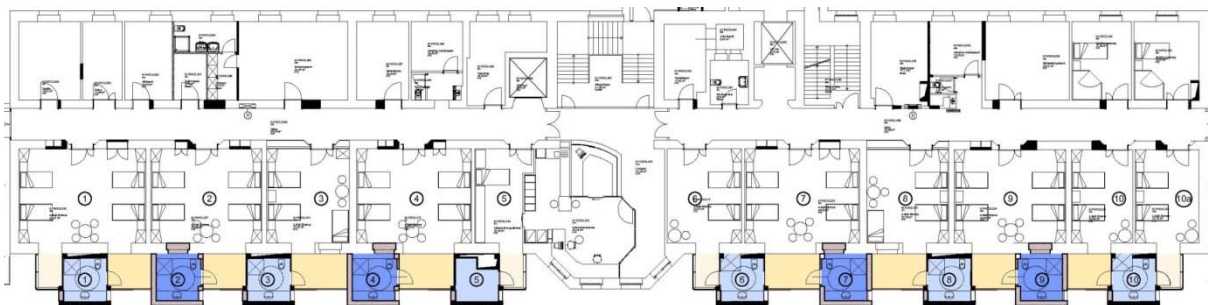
Grundriss LKH Laas, Kötschach-Mauthen; Die hellblauen Sanitärtürme wurden 1997 erweitert. Die dunkelblauen Sanitärtürme sollen im Herbst 2014 ergänzt werden.
